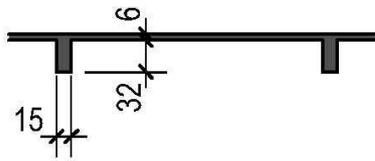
Querschnitt Rippendecke Detail [Walter Reif Ing. GmbH]
